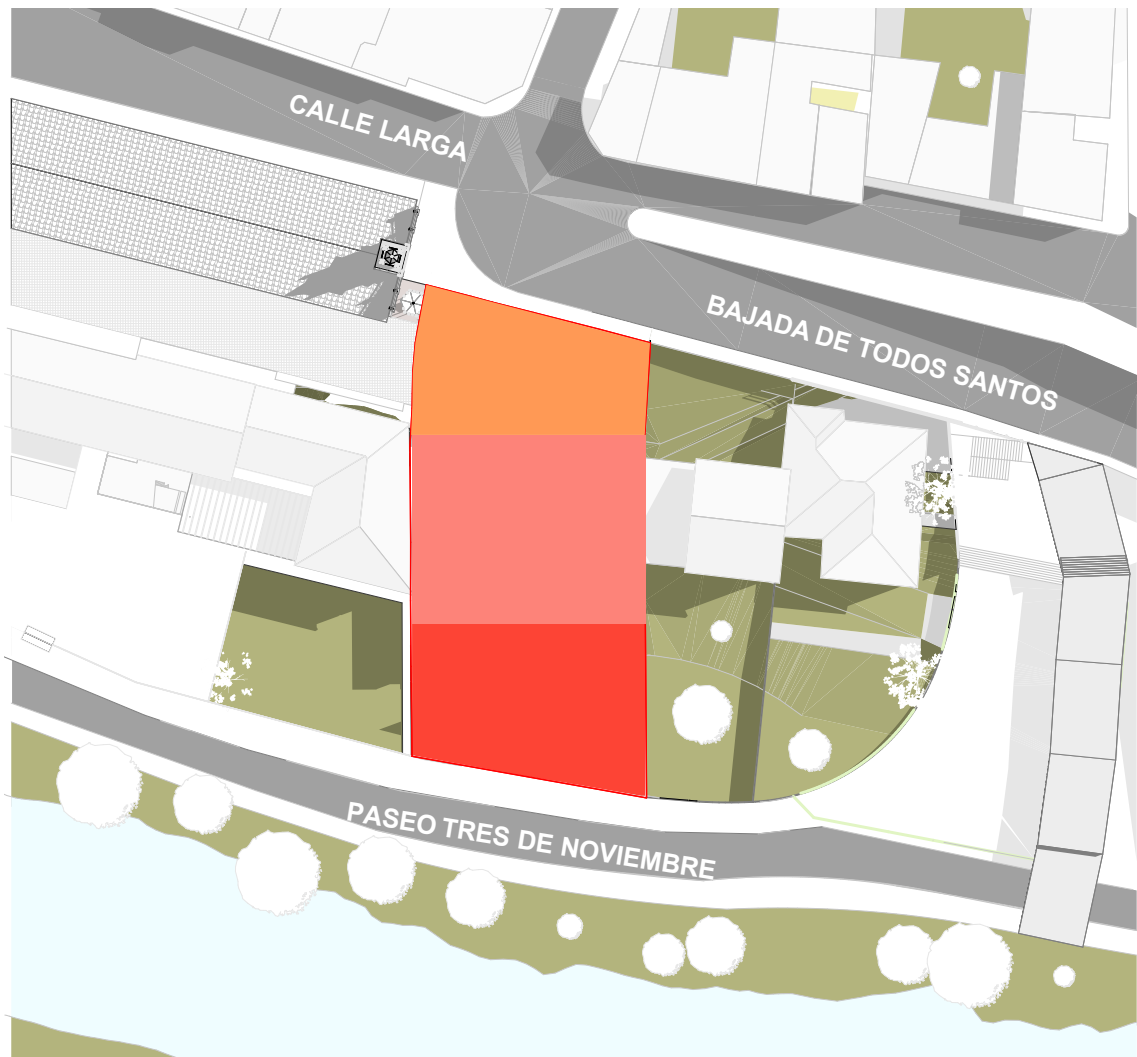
Vista en planta de las plataformas. Fuente: Elaboración propia.
